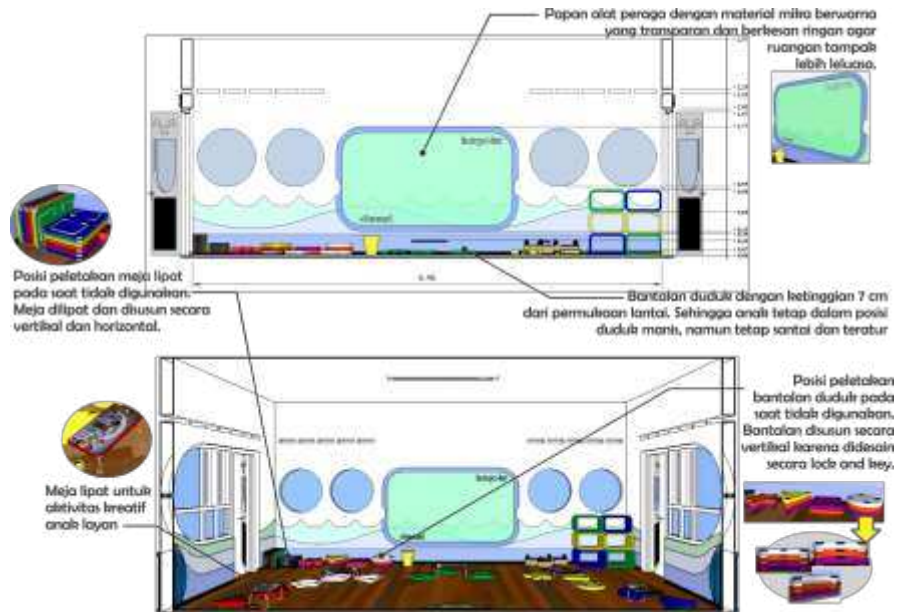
Denah dan Denah Orthogonal Ruang Kelas AK
